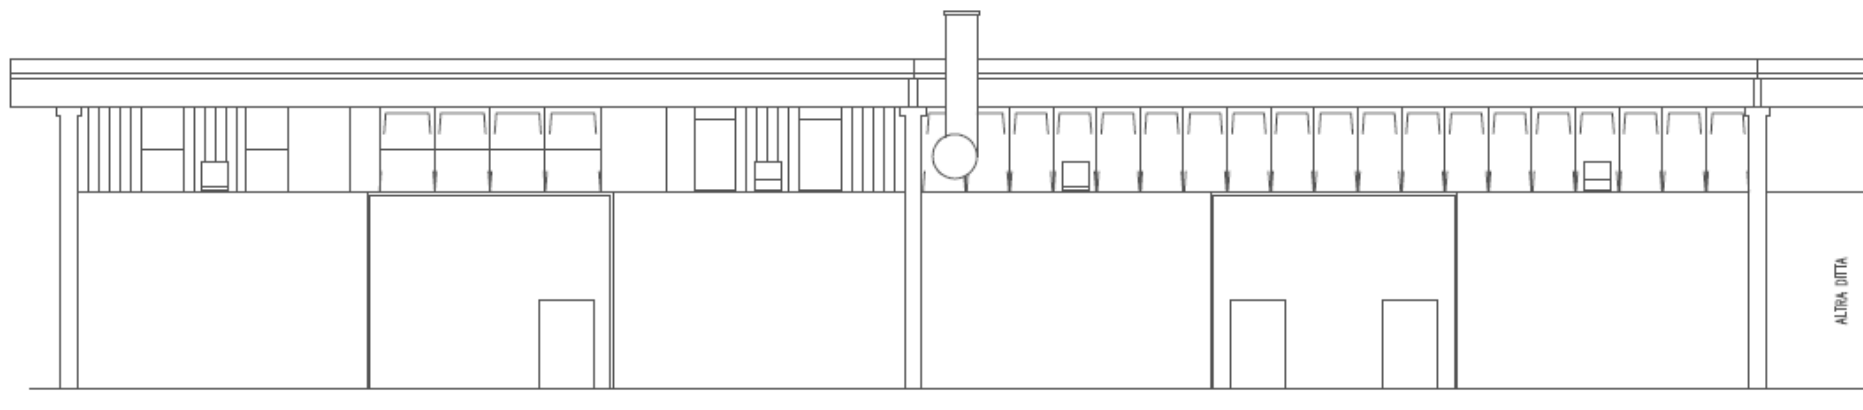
Prospetto del retro (rispetto la vista dell'ingresso principale) dello stabilimento.
